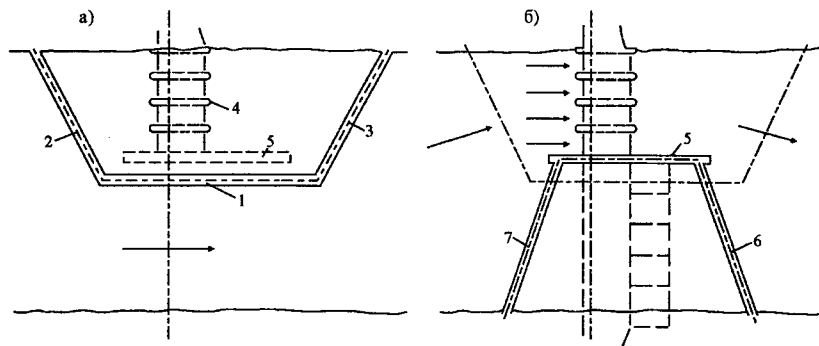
Схема расположения перемычек котлована гидроэлектростанции: а – перемычки первой очереди, б – перемычки второй очереди: 1 – продольная перемычка, 2 – верховая перемычка 1-й очереди, 3 – низовая перемычка 1-й очереди, 4 – водосливная плотина, 5 – раздельный устой, 6 – низовая перемычка 2-й очереди, 7 – верховая перемычка 2-й очереди
